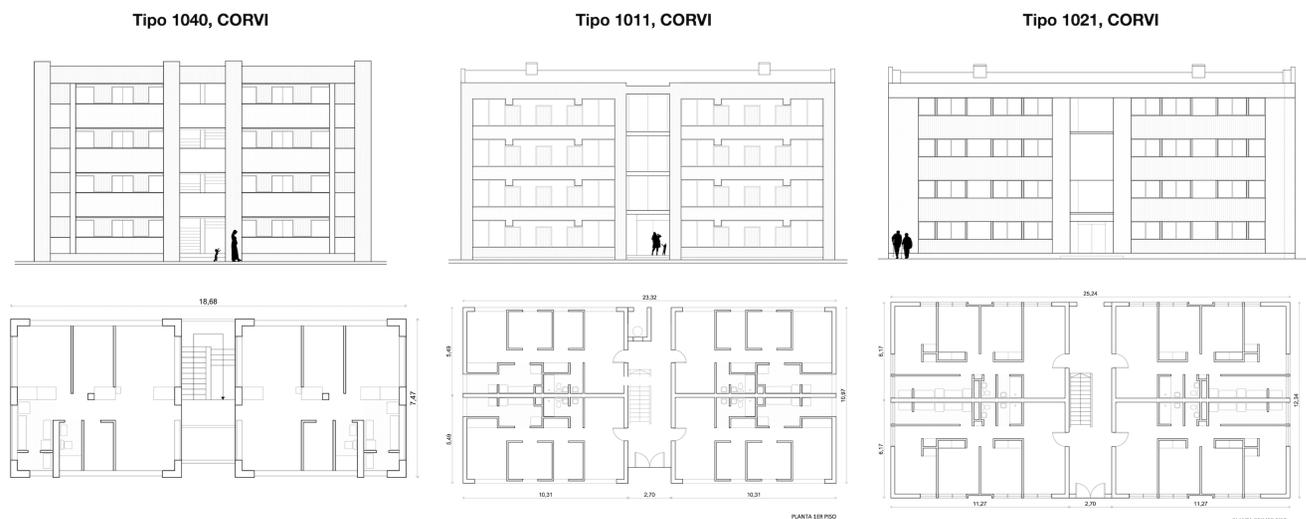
Elevación y plantas de Colectivos de Vivienda tipo 1040, 1011 y 1021, Corporación de la Vivienda. Fuente: Elaboración propia.
